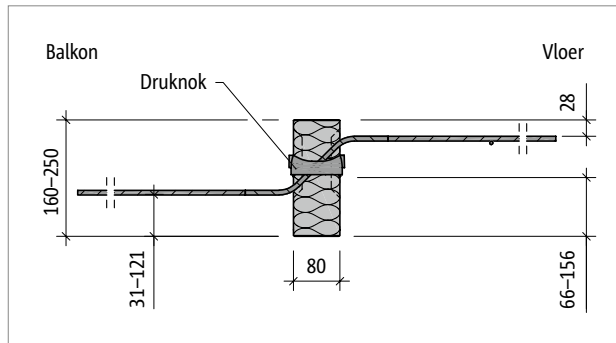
Schöck Isokorf® T type Q-E-V6: Bovenaanzicht, L500
